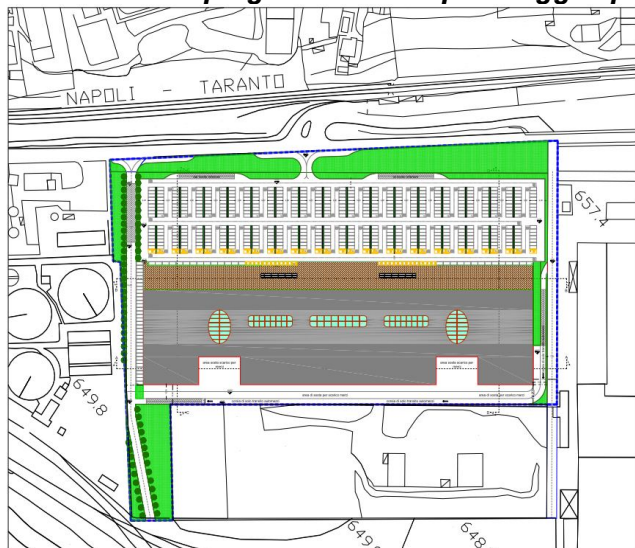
Planimetria di progetto – aree di parcheggio quota +0,00 m
